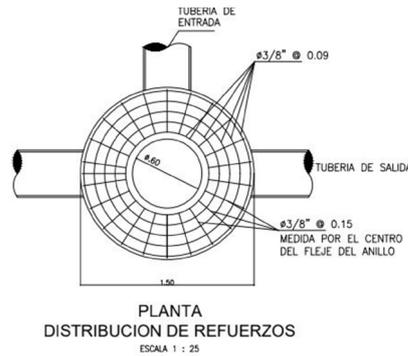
Diseño planta Tapa recamara Belmonte
